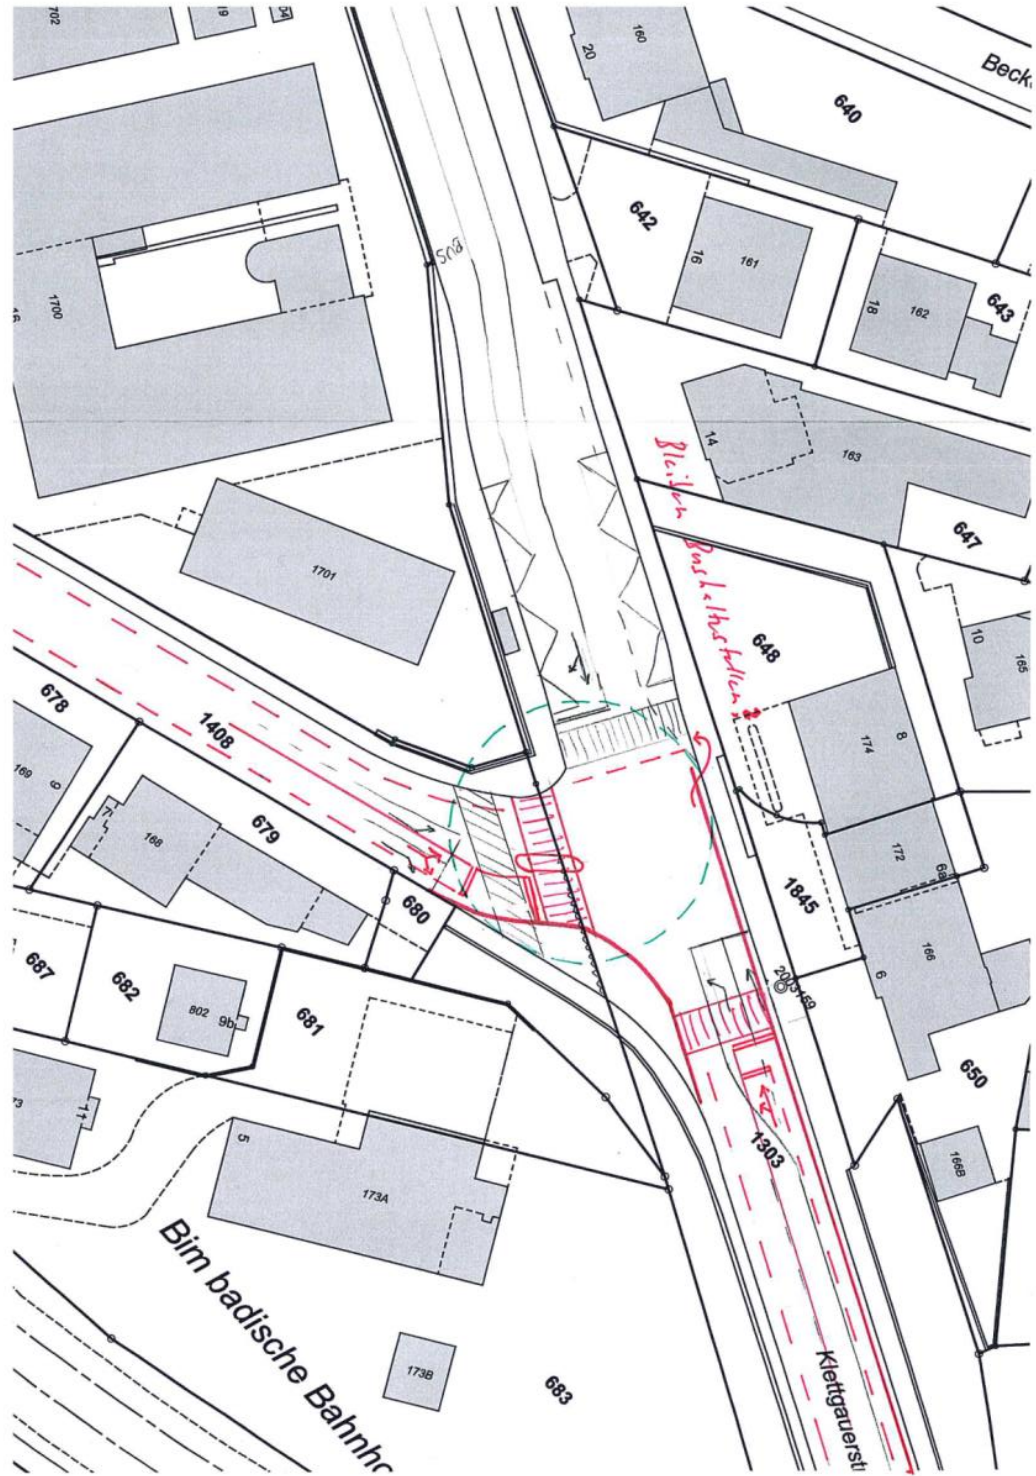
Situation Knoten. Bad. Bhf.-/Klettgauerstr.
